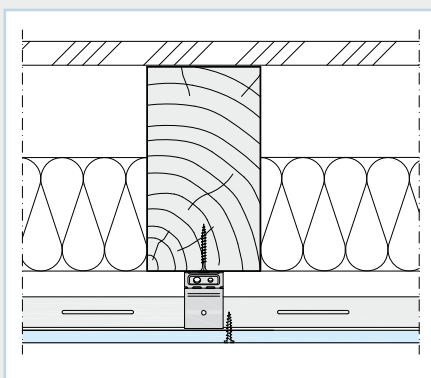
Holzbalkendecke mit Unterdecke ohne Estrich
